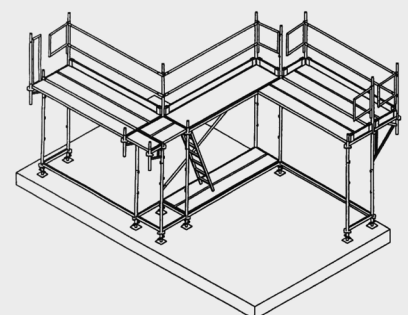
Plan zum Projekt „Gerüst-Doppelecke“
